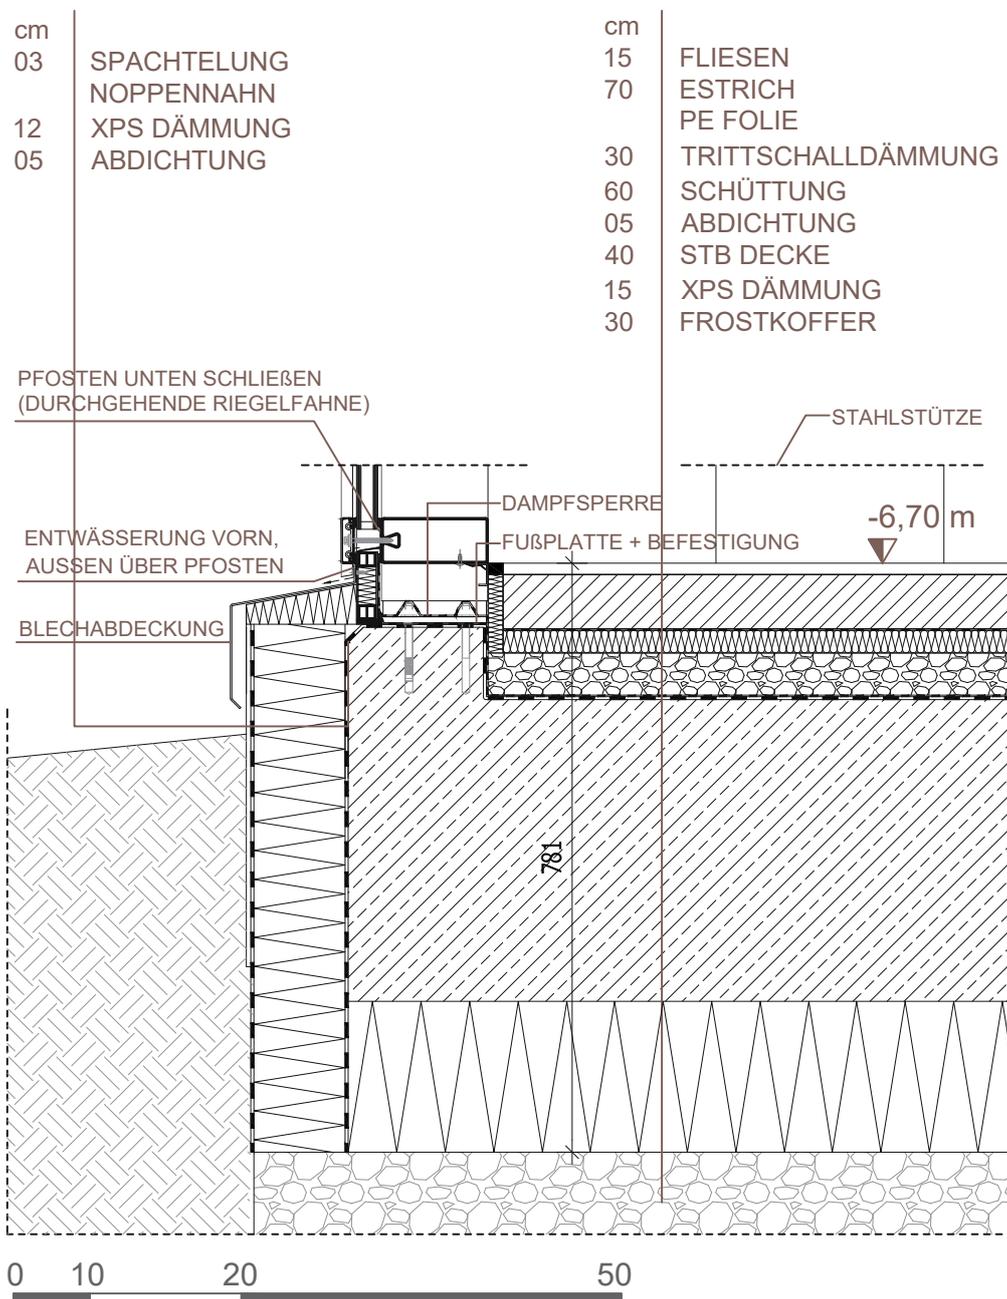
Detail Pfosten-Riegel-Fassade und Fundament
